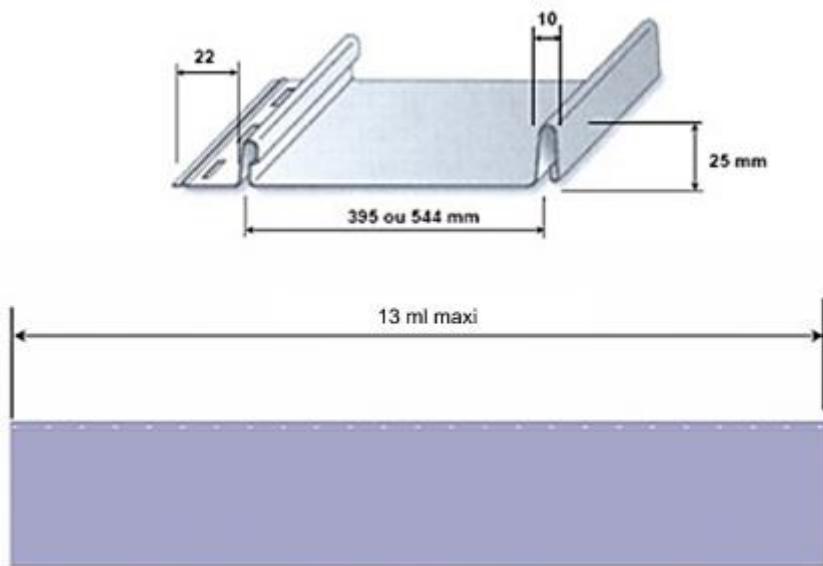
Profils Styl'inov® – Profil n° 3 - joint de 25 mm
